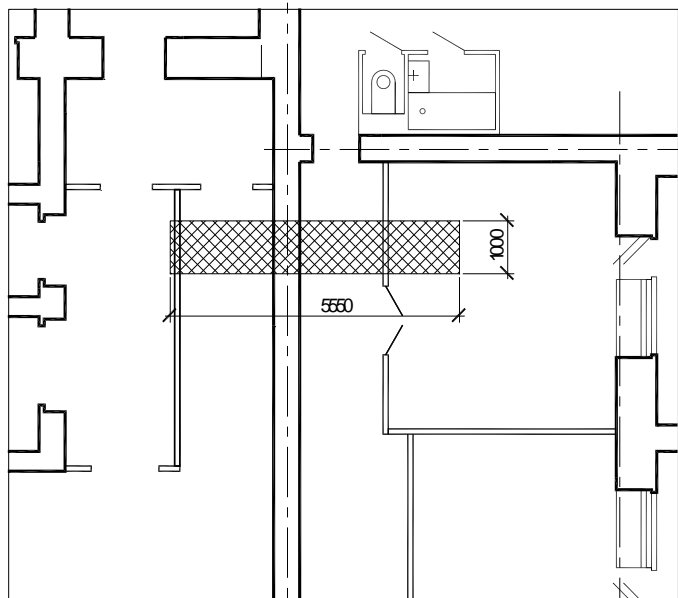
Грузовая площадь для внутренней стены 12-этажной секции
